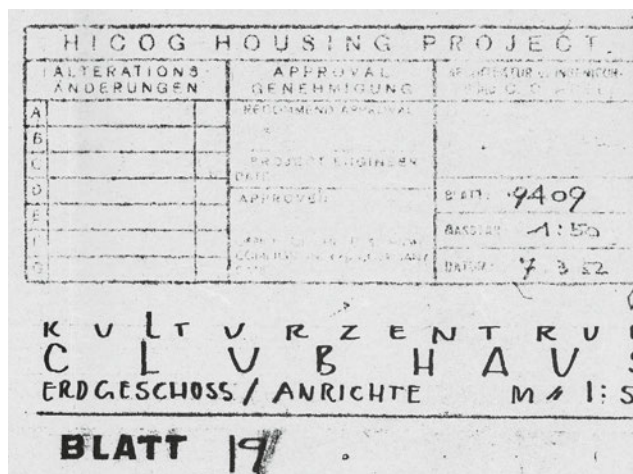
Plankopf des Baueingabeplans für das Hauptgeschoss, Kulturzentrum. Clubhaus v. 7. März 1952. Bauordnungsamt der Stadt Bonn, Bauakte 4563
